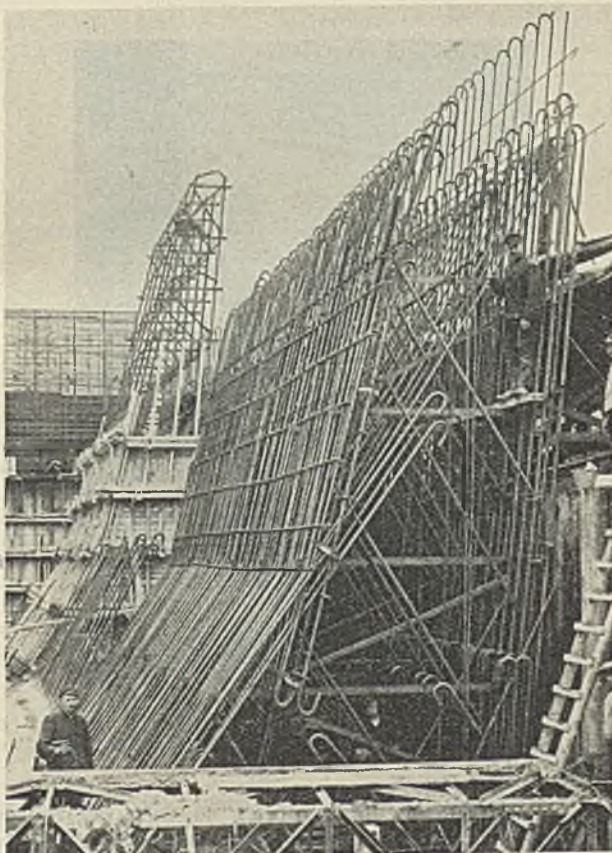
Dockverlängerung, Bewehrung der Wände.
